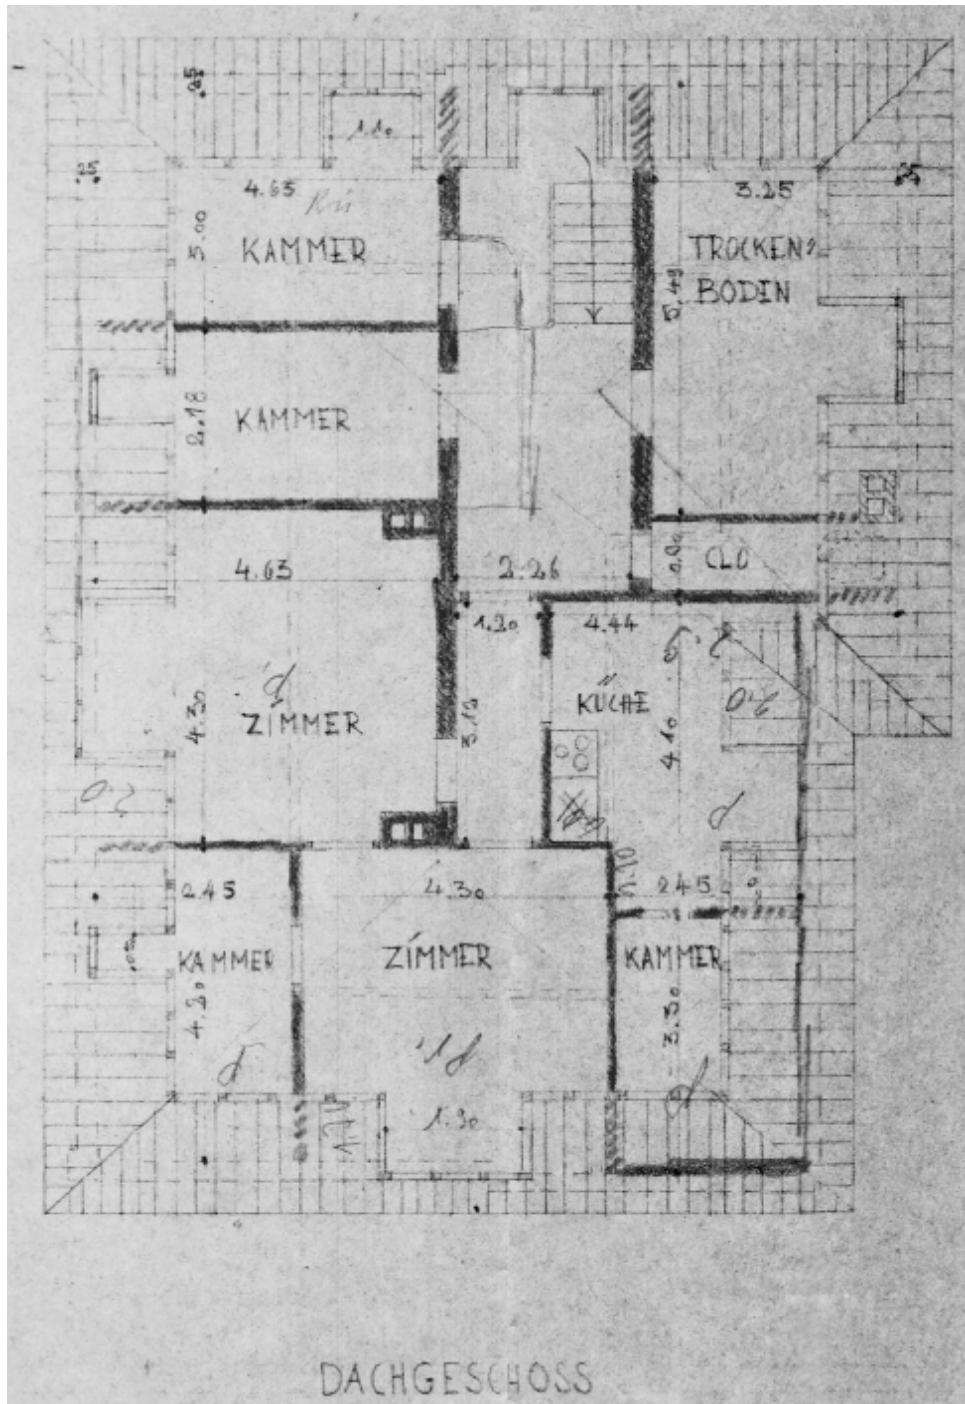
Grundrissplan Dachgeschoss; Quelle: Bauakte der Stadt Hanau
